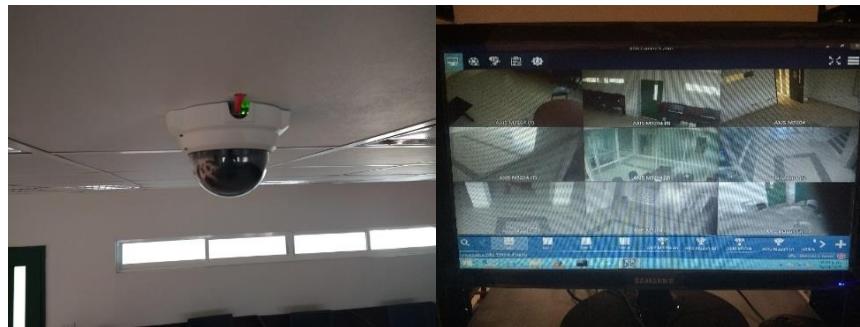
Configuración de cámaras IP en el edificio C planta baja y primera planta.
